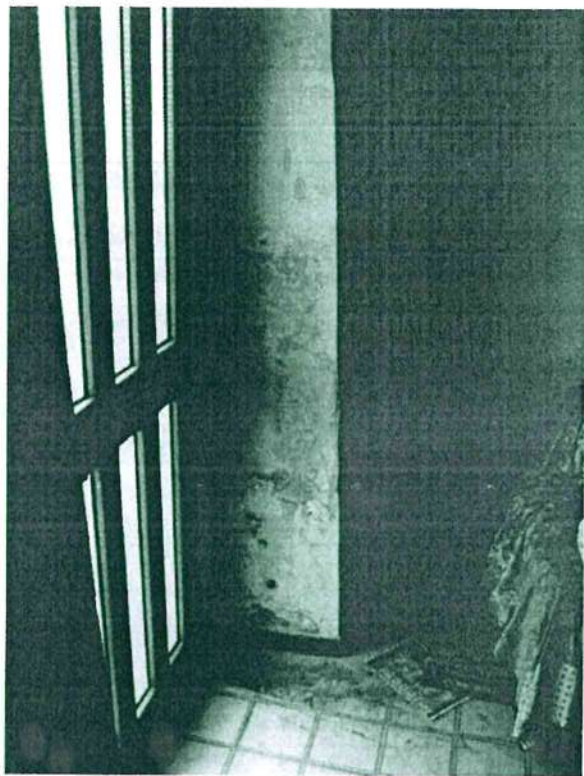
Vista interna dell'ingresso dalla via Nemi.
